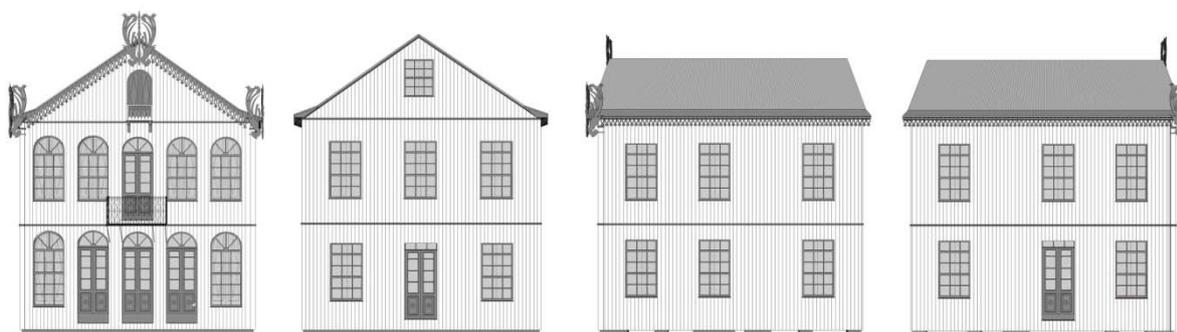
Casa Bocchese: fachada Rua Luiza Bocchese, orientação Leste. Figura 10 – fachada posterior, orientação Oeste. Figura 11 e 12: fachadas laterais, orientação Norte e Sul, respectivamente. Desenhos da autora.
